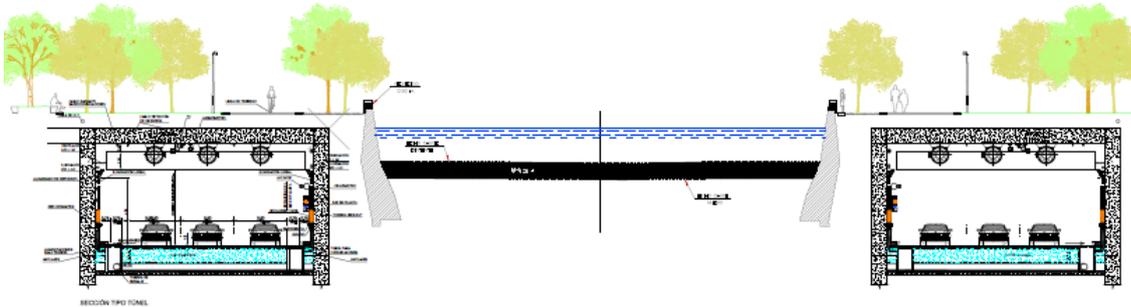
Túnel M30-Río. Sección transversal del túnel junto al río. 3 carriles
